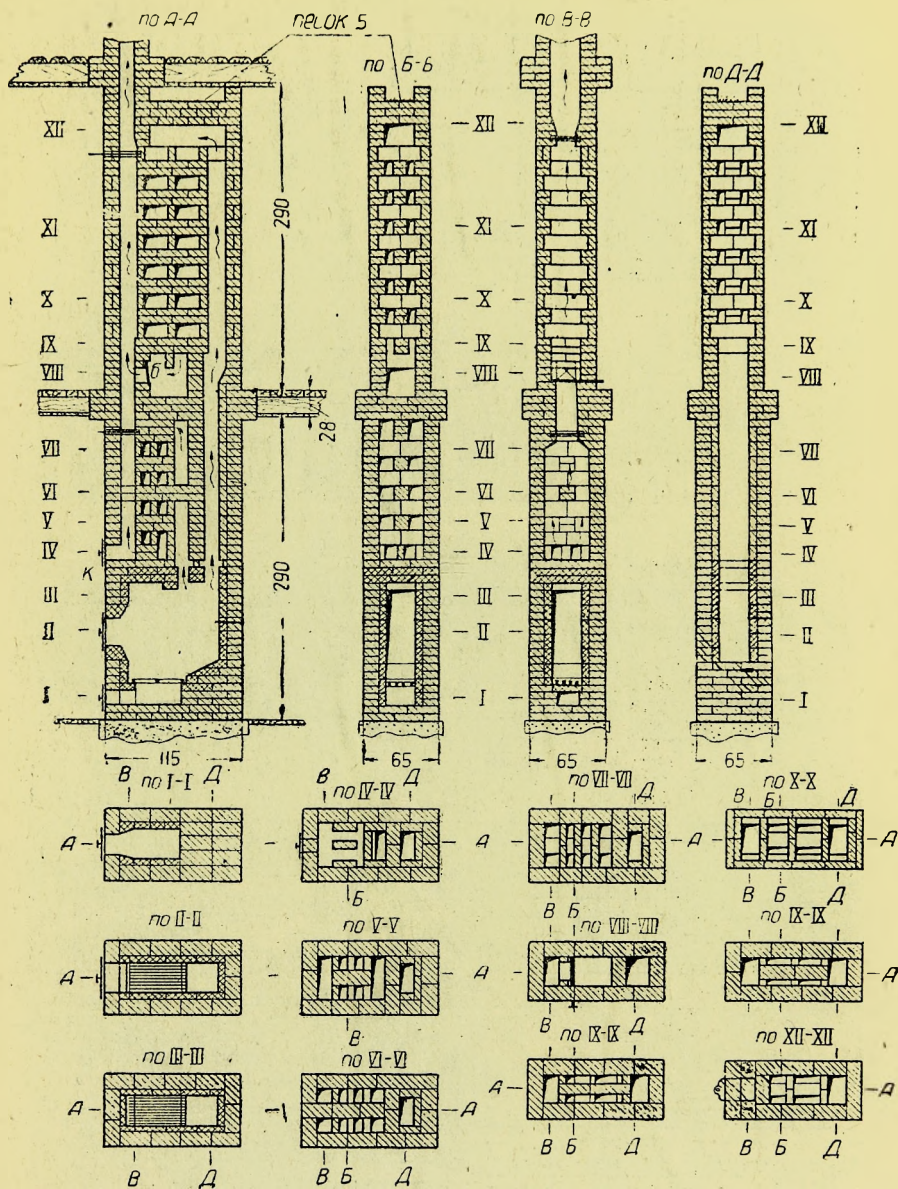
Двухэтажная печь И. Ф. Волкова колпаковой системы с колпаком решетчатой конструкции геплоотдачей на 2500—3000 калорий.
